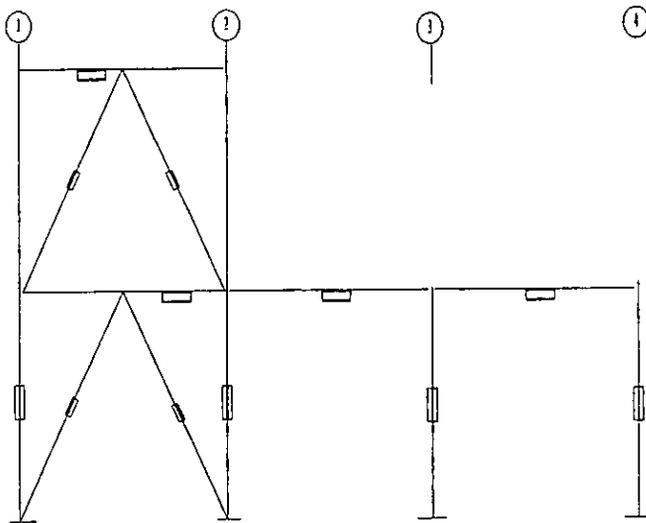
ELEVACIÓN MARCO EJE "B"
